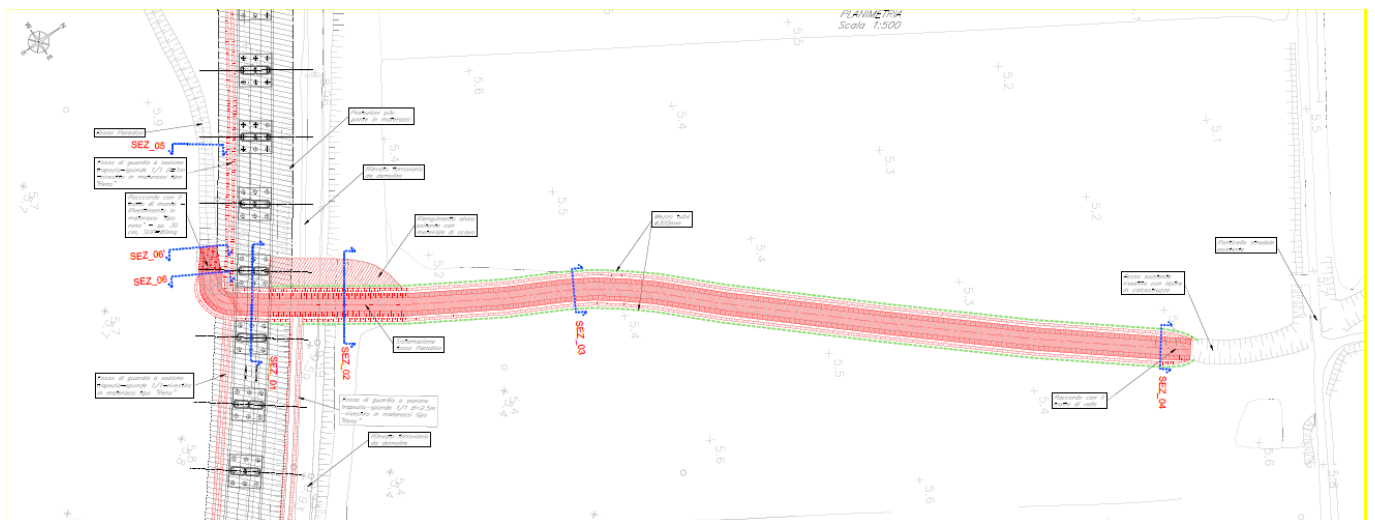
Sistemazione Fosso Paradiso con attraversamento al di sotto del viadotto
